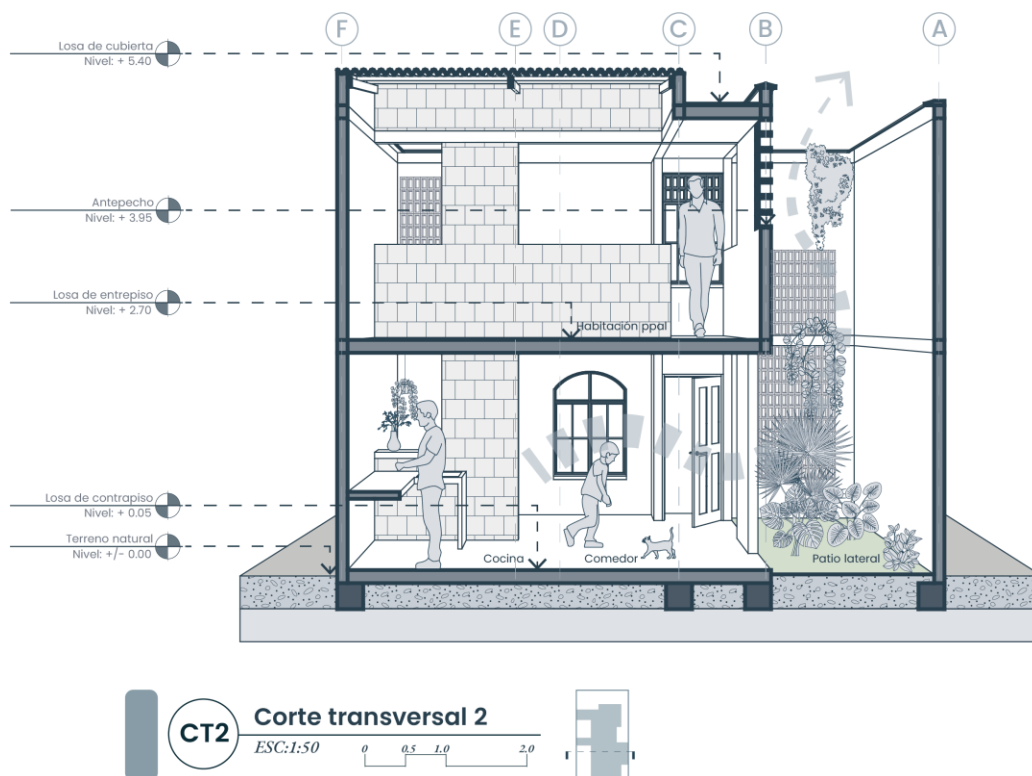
Corte transversal 2 Casa Patio. Elaboración propia.
